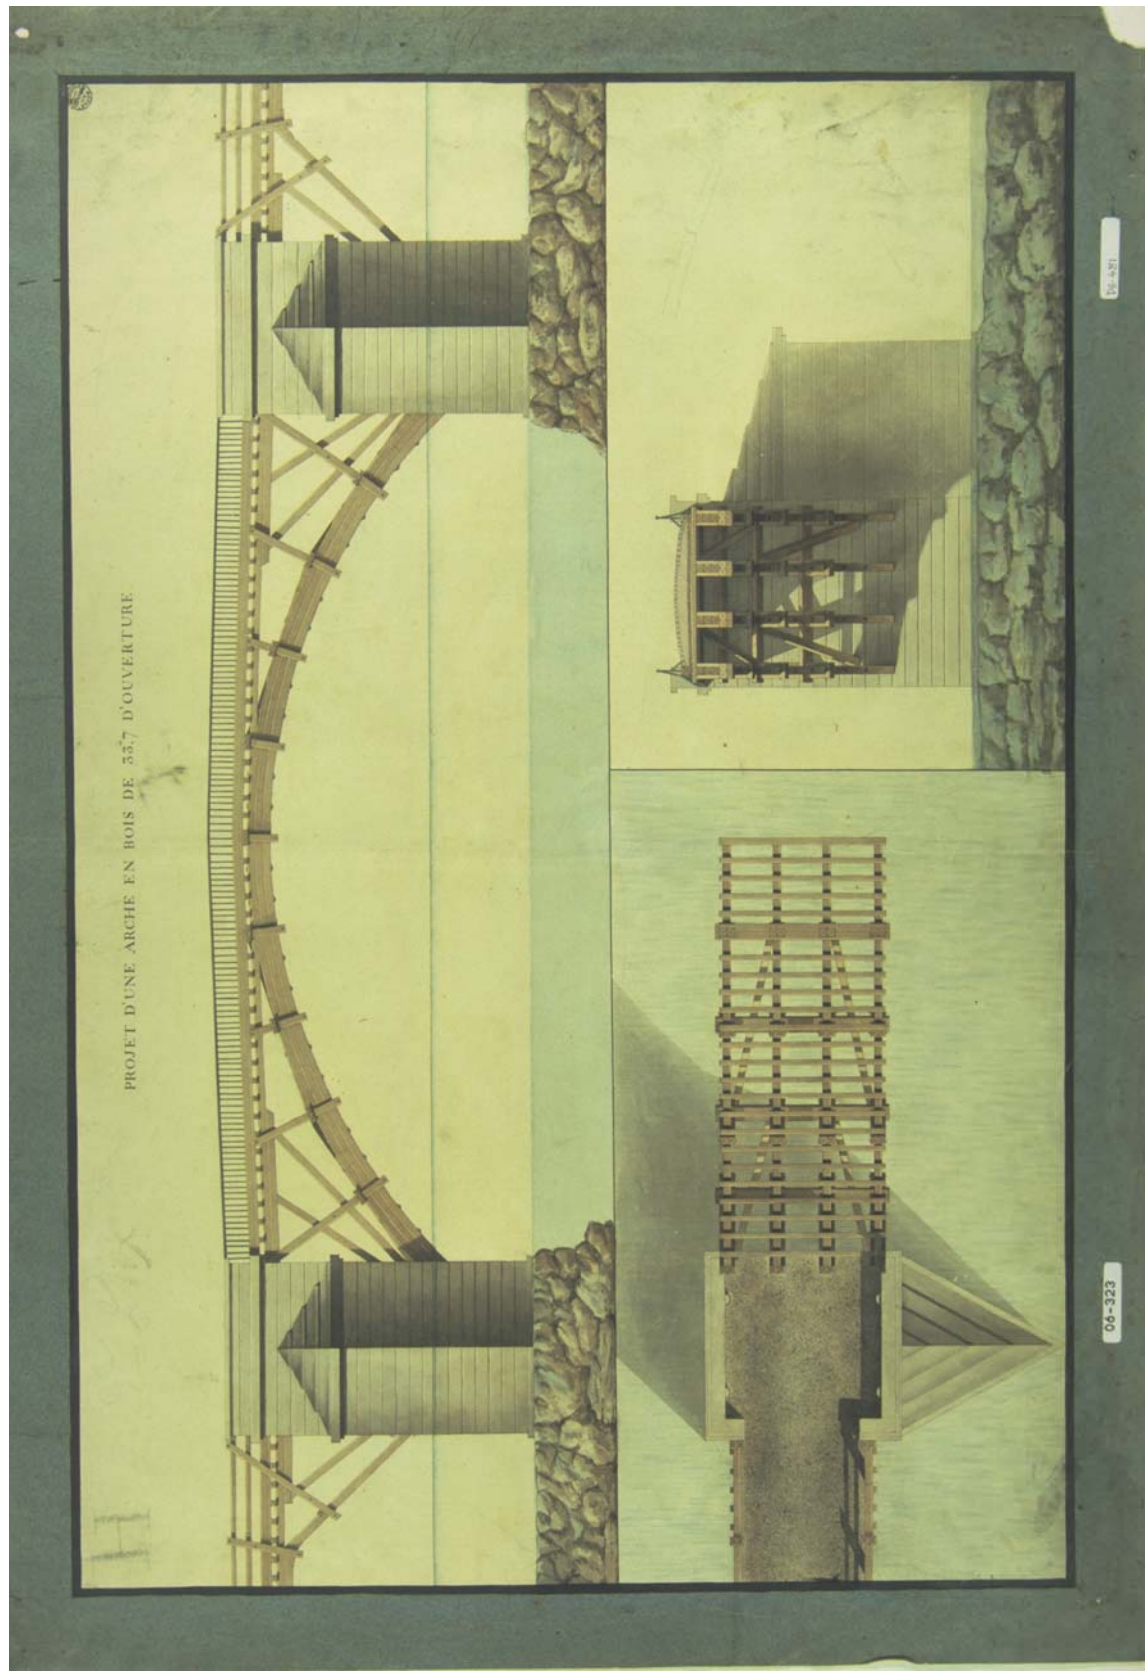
DG 481 – Charles Joseph Minard. Projet d'une arche en bois de 33,7 m d'ouverture. Concours architecture. Elevation, plan et coupe. Arco e puntoni a sostegno dell'impalcato. 1812
